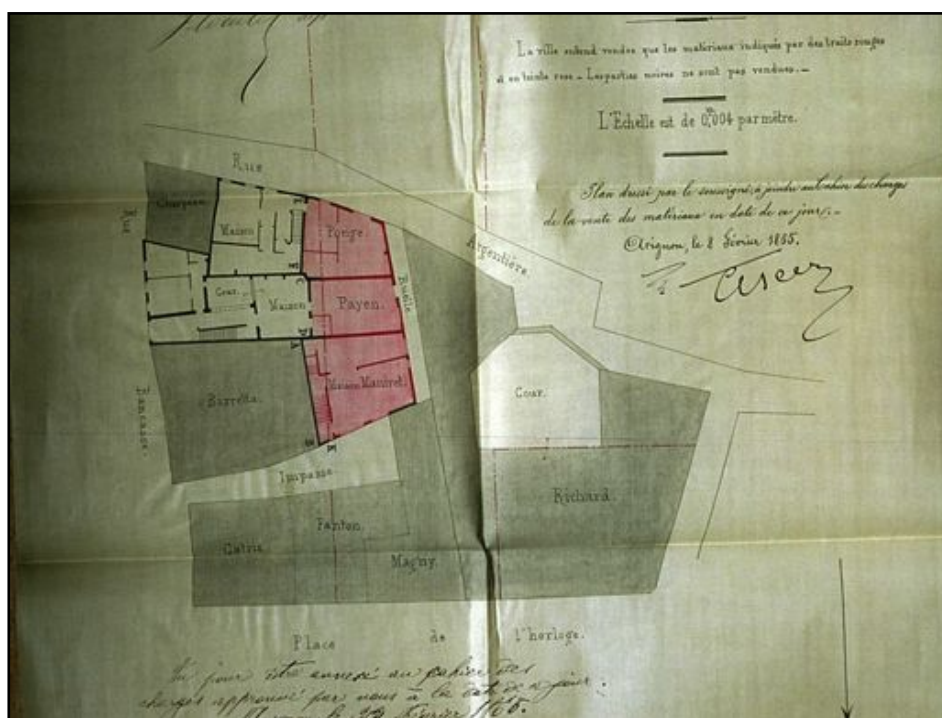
Plan des Rez-de-chaussée entre la rue Argentière et la place de l'Horloge - (AMA)
